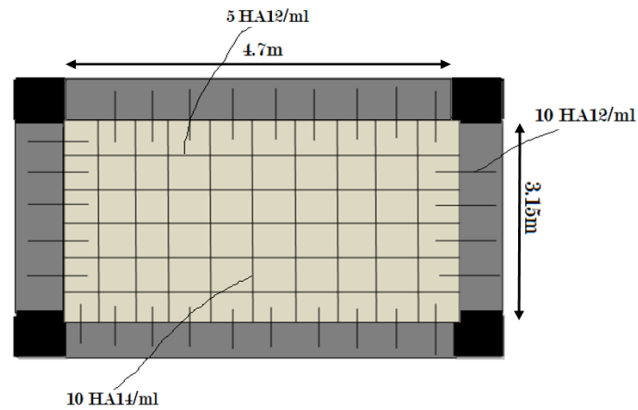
Schéma de ferrailage de la dalle pleine type N° 3
